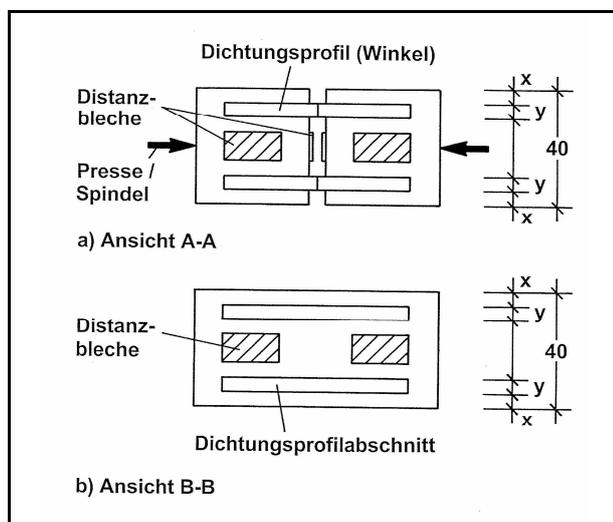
Betonprüfkörper für den Abplatzversuch (Grundriss)
